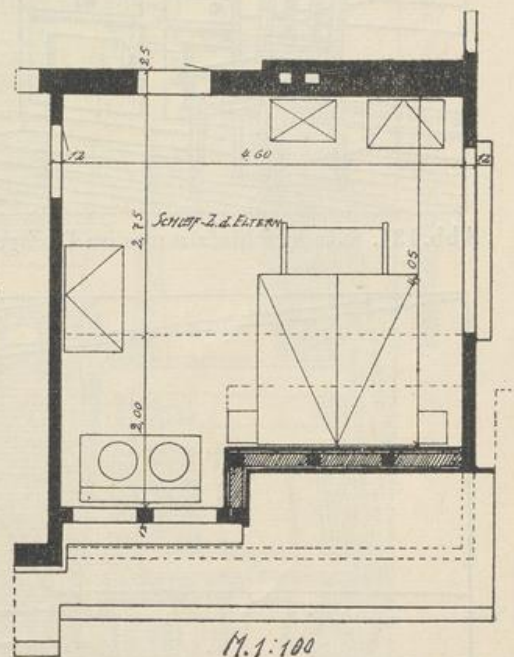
Besseres Elternschlafzimmer im Dachgeschoß mit Ofen.
